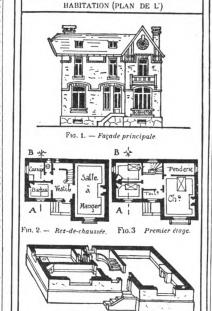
Comments'explique le plan du rez-de-chaussée
